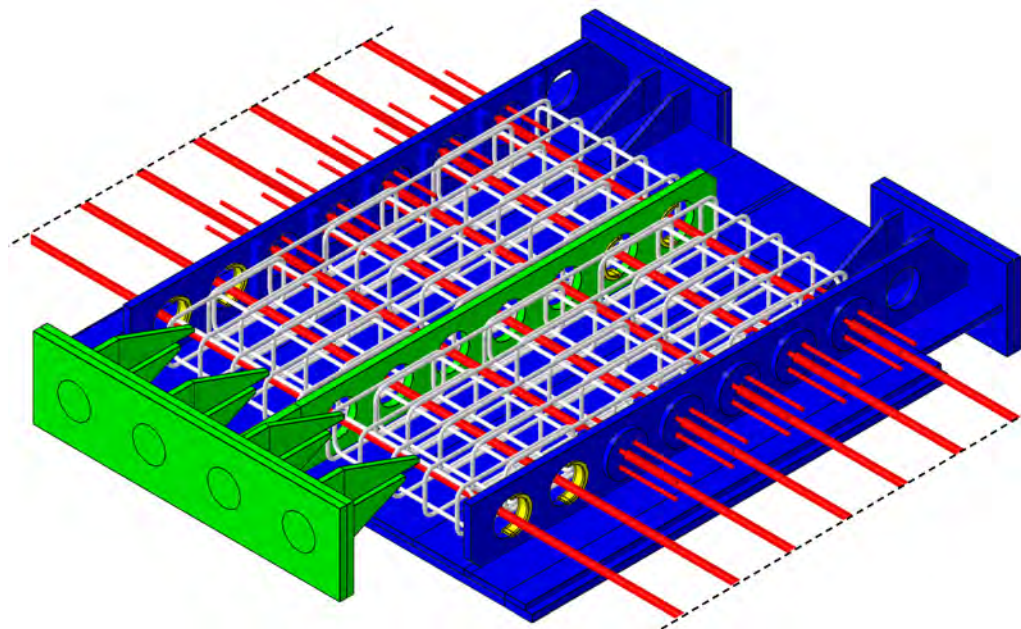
Versuchskörper VK1/4, mit Zug, mit Längs- und Bügelbewehrung
